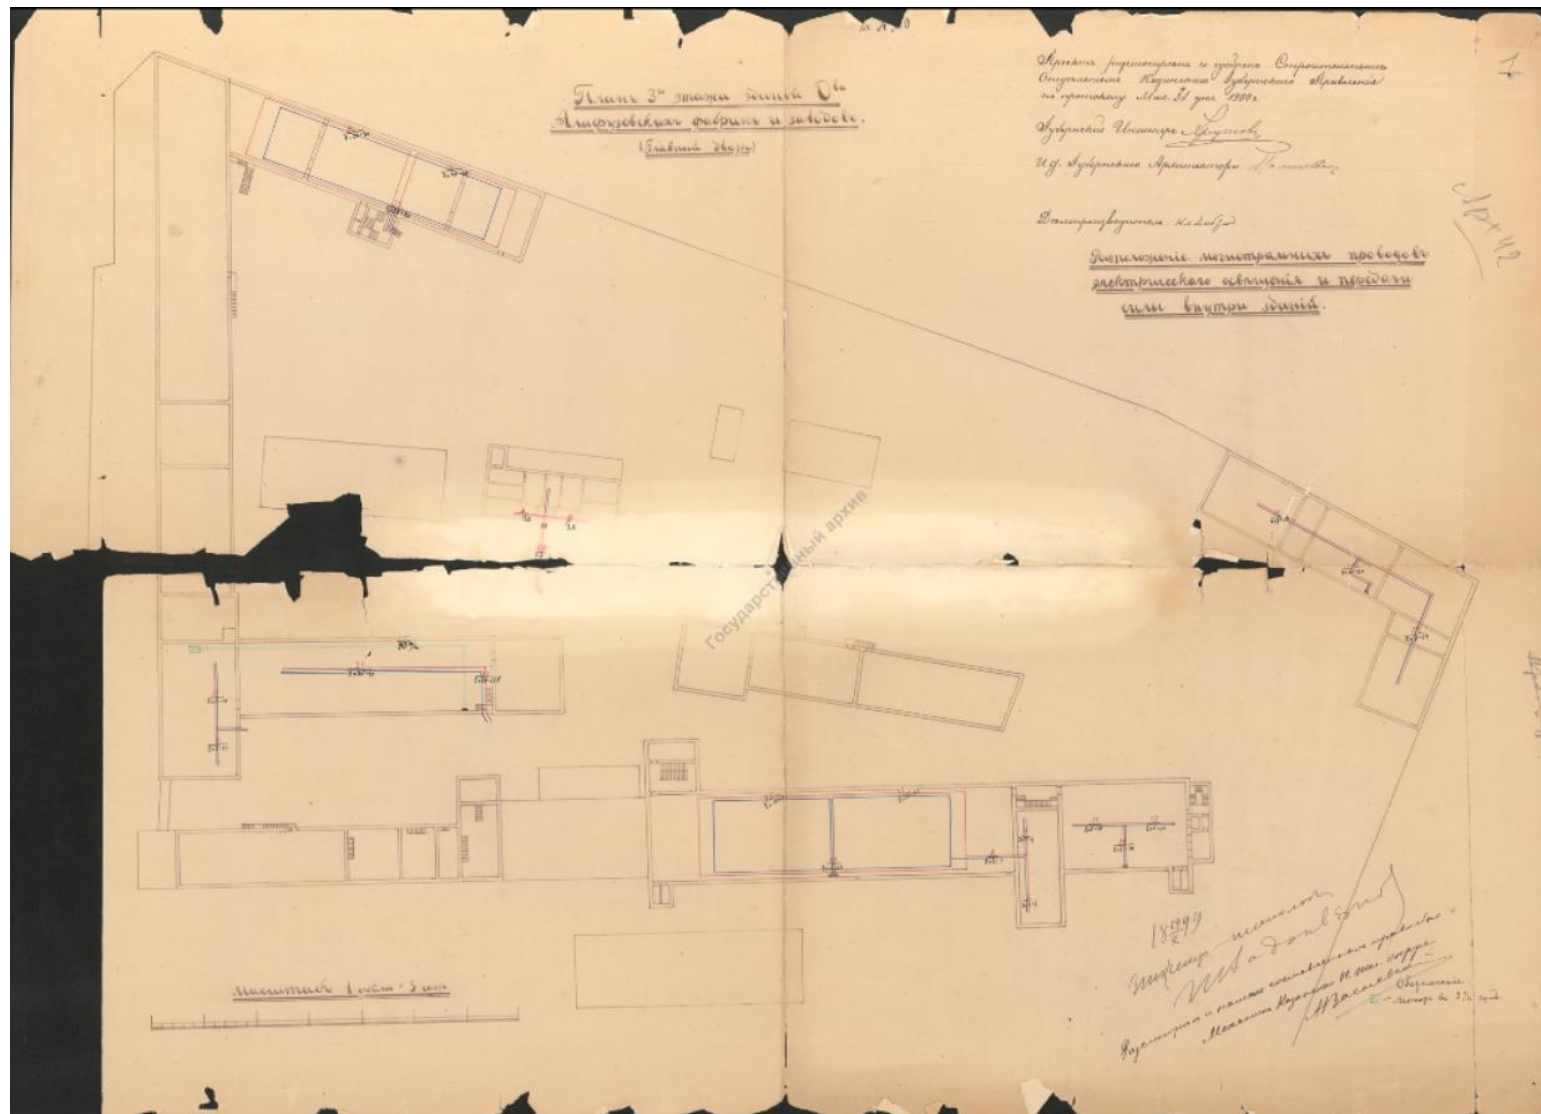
План 3-го этажа здания общества Алафузовских фабрик и заводов ф.2, оп.15, д.604
